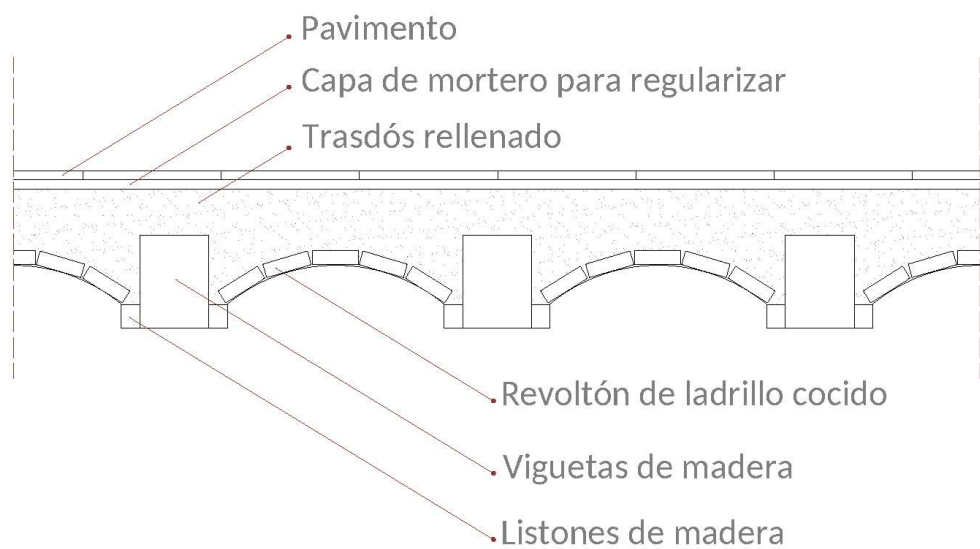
Detalle constructivo del forjado de revoltones de ladrillo. Elaboración propia.
